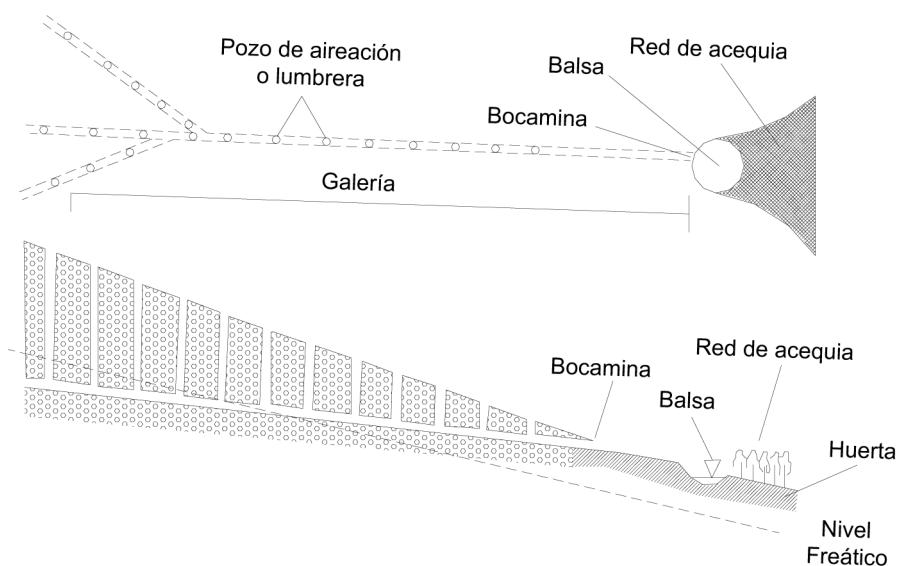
Perfil y planta de una foggara. Fuente: WaterHistory.org
